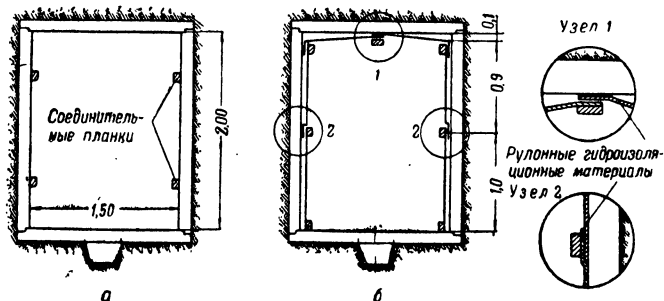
Схемы устройства гидроизоляции полевых подземных сооружений из рулонных материалов
